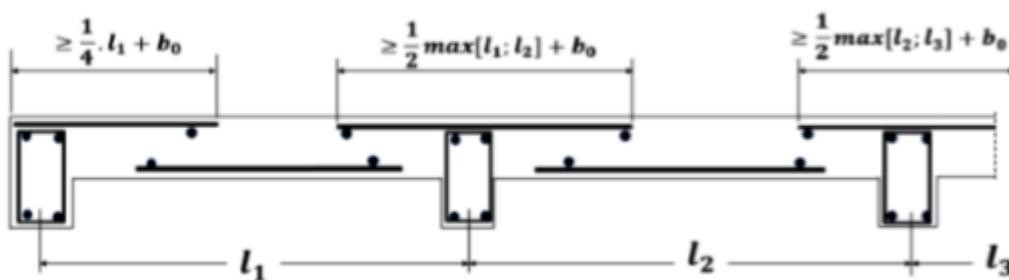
disposition constructive des armatures d'une dalle pleine [4]
